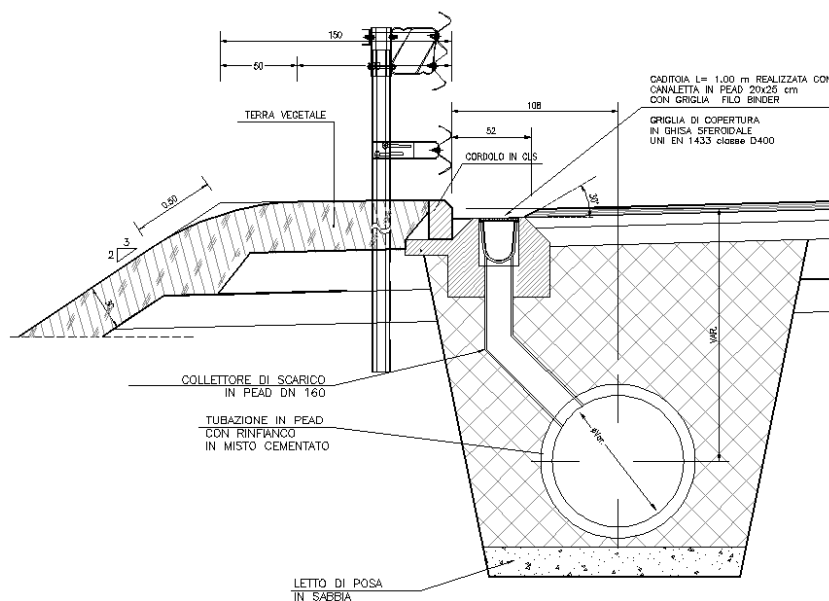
sezione tipo elemento di drenaggio in rilevato.
